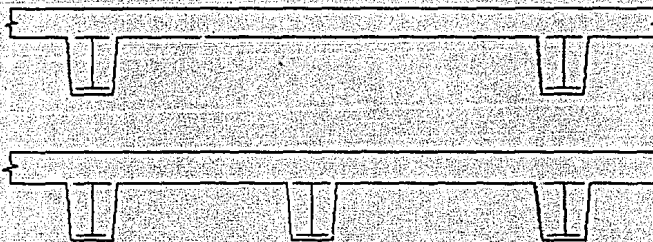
SISTEMA VIGUETAS - LOSA ENCAJETONADA
